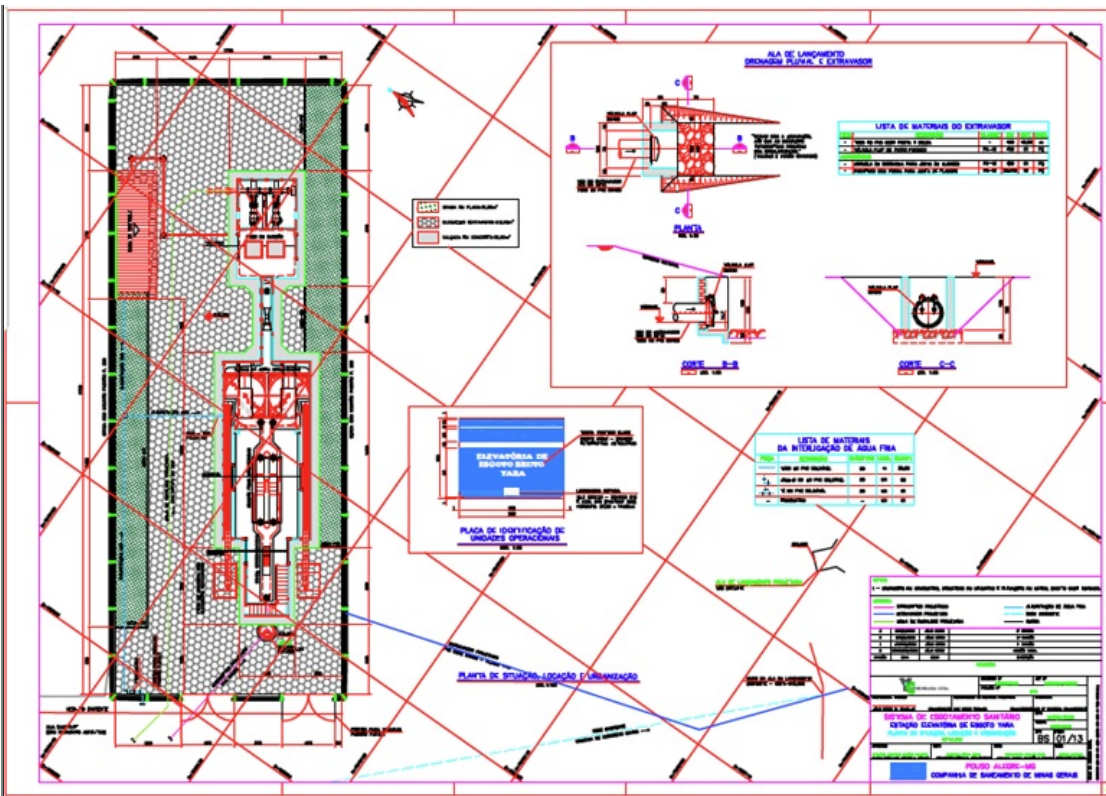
Planta da Estação Elevatória de Esgoto YARA, a ser instalada no Rio Mandu, situado no Bairro Yara, Município de Pouso Alegre/MG.
